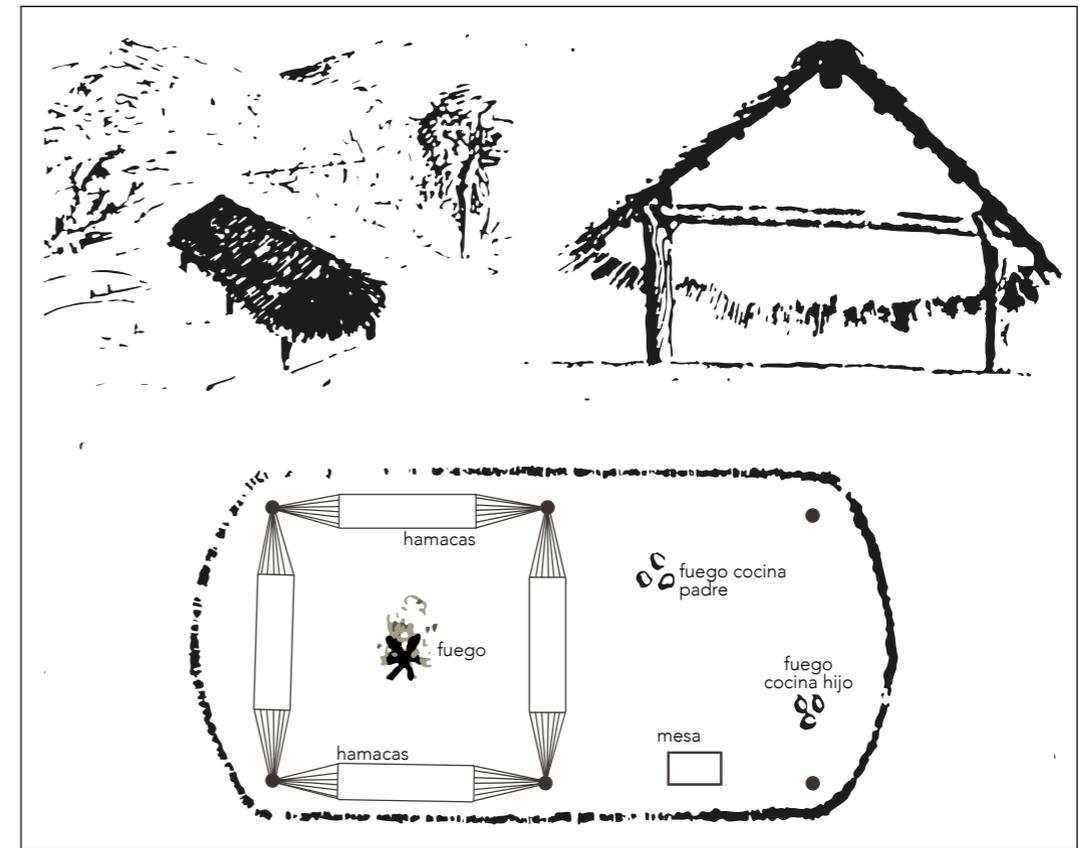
Planta y alzados de las casas de Kayum, Lacanjá, Chiapas.
